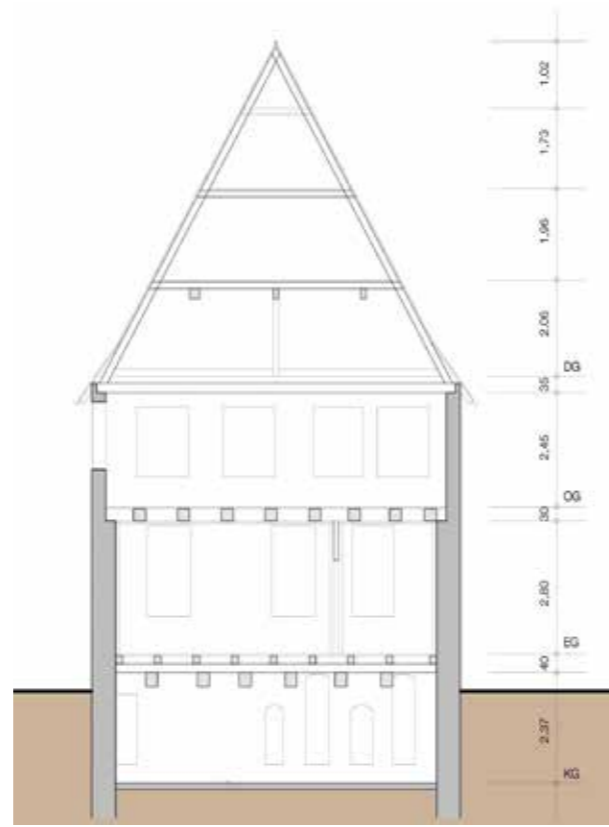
Schnitt durch den rückwärtigen Gebäudeteil.
